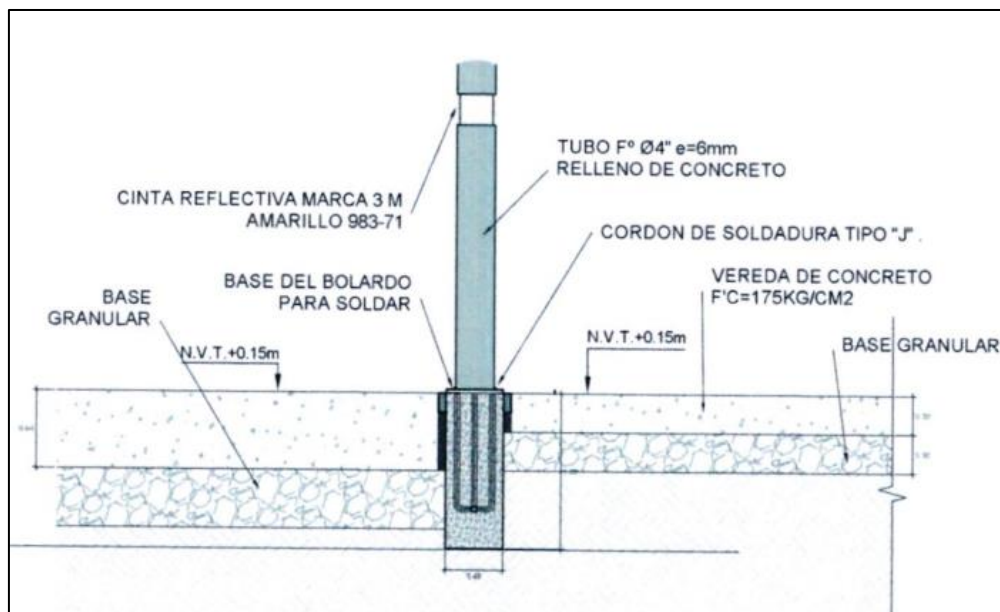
Propuesta cordón de soldadura en bolardo.
